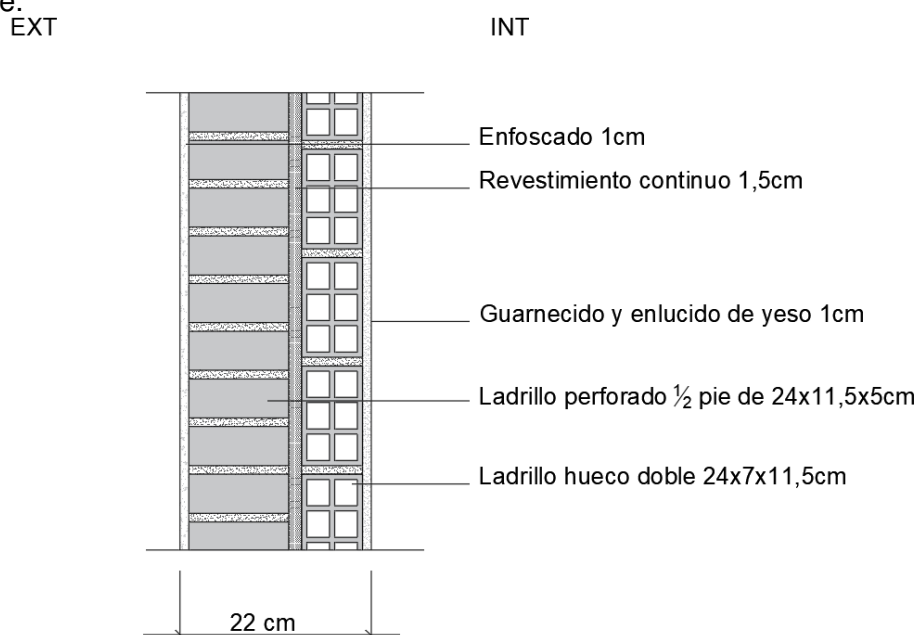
Detalle sección medianería Fuente propia programa AutoCAD
